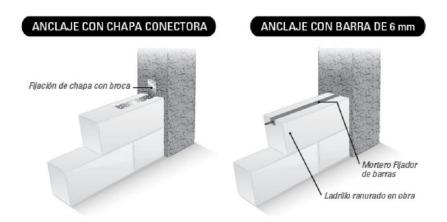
Tipos de anclaje entre mampostería de hormigón celular y columnas de H°A°. Fuente: Manual constructivo de ladrillo de marca reconocida.
